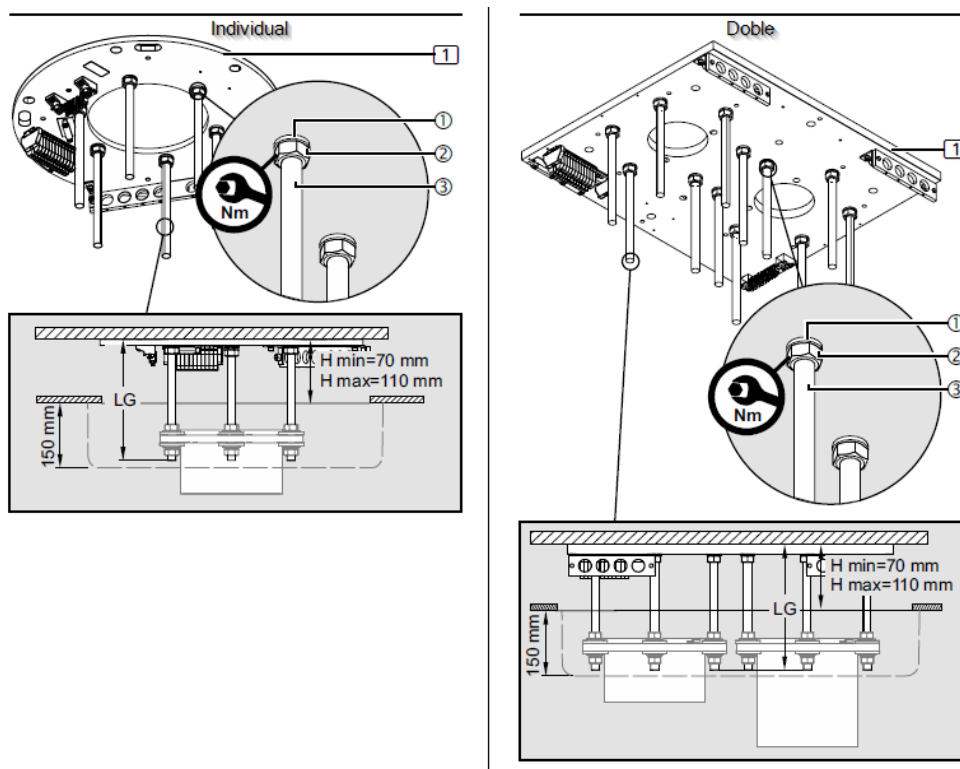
Installation de la plaque d'interface avec le plafond suspendu
